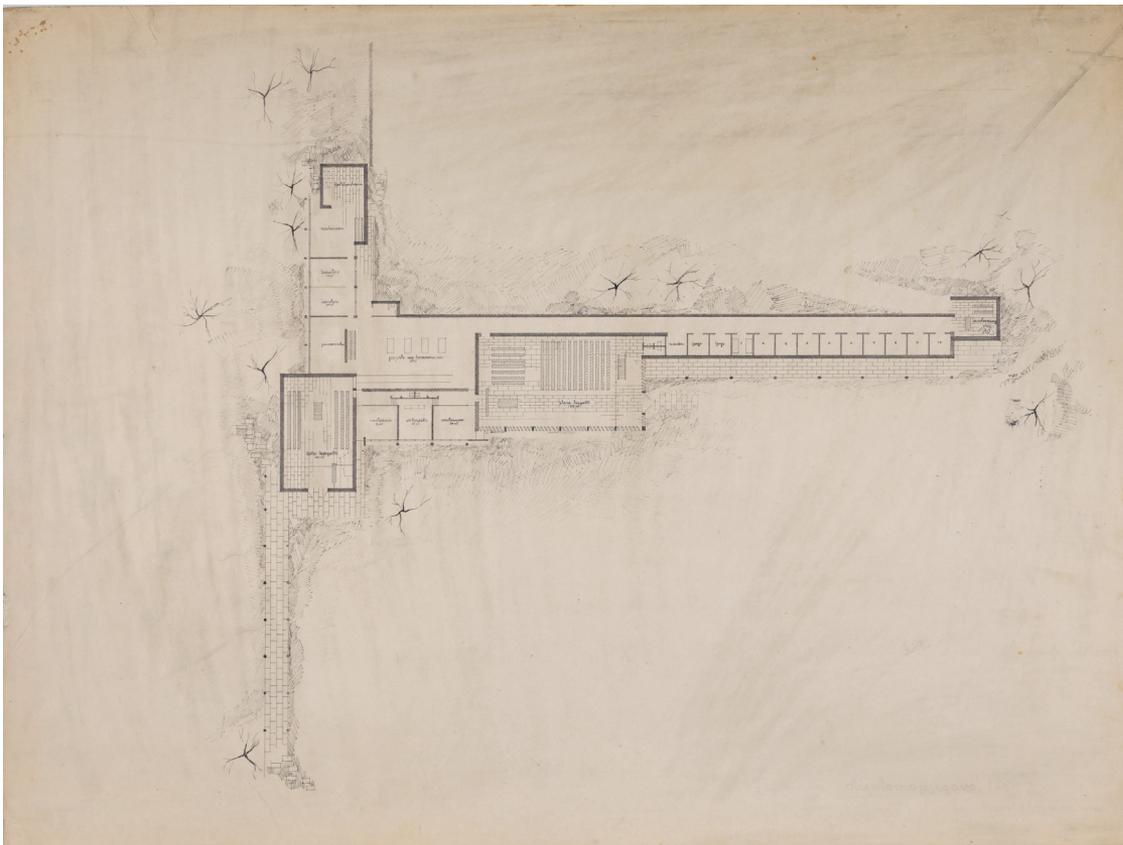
Disegno di archivio. S. Fehn, Progetto di tesi per un crematorio, pianta del piano terra, 1949.
